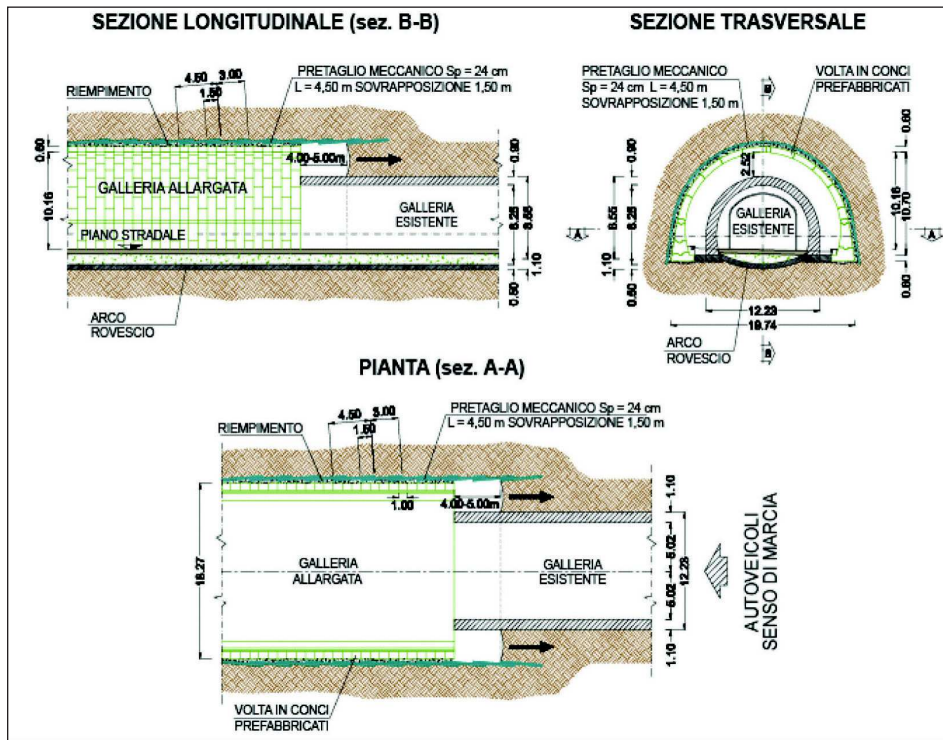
Sezione tipo con pretaglio meccanico (progetto Rocksoil S.p.A.).
